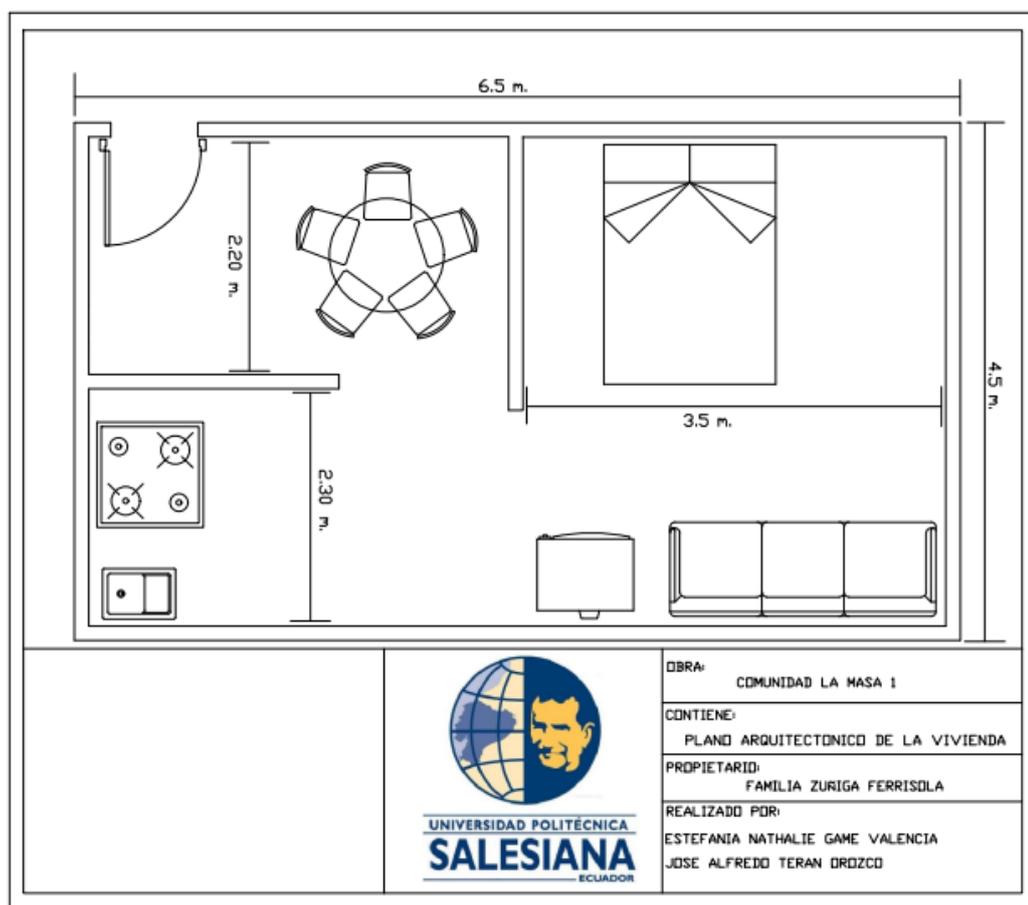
Plano arquitectónico de la vivienda (Fuente: Autores).
